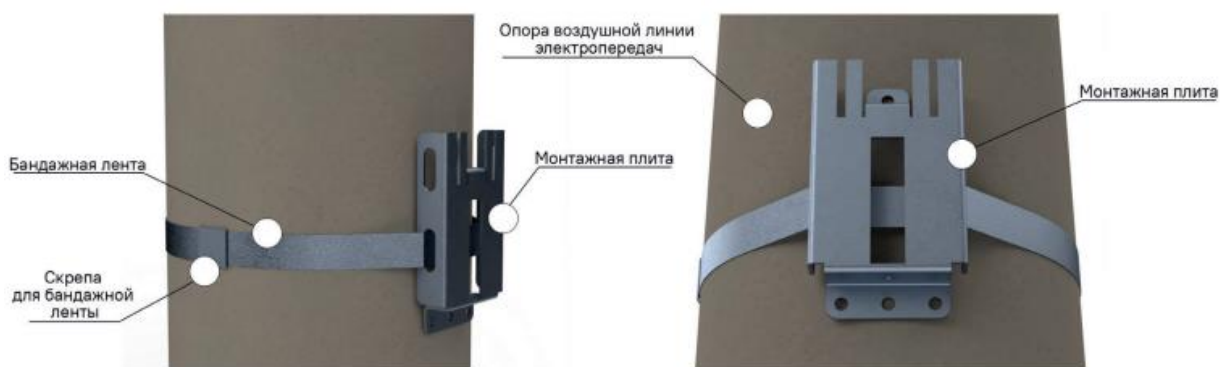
Установка монтажной плиты на опоре для блока измерительного счетчика НАРТИС-И100-SP1
